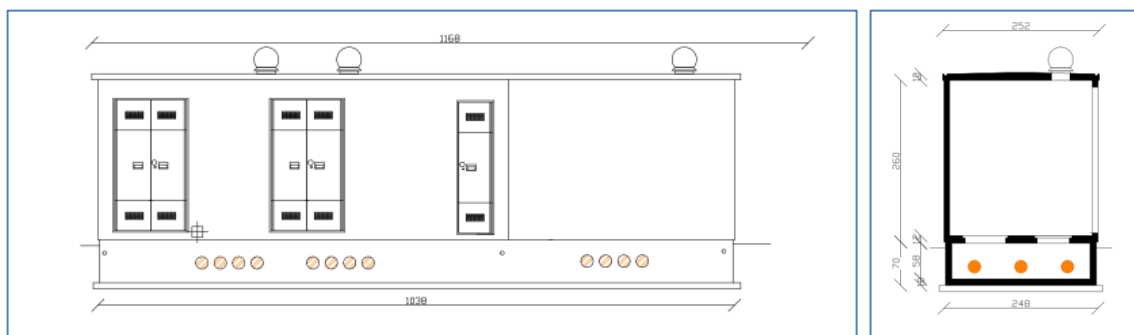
Prospetto lato strada e sezione tipo della cabina di consegna con posizionamento su vasca di fondazione
